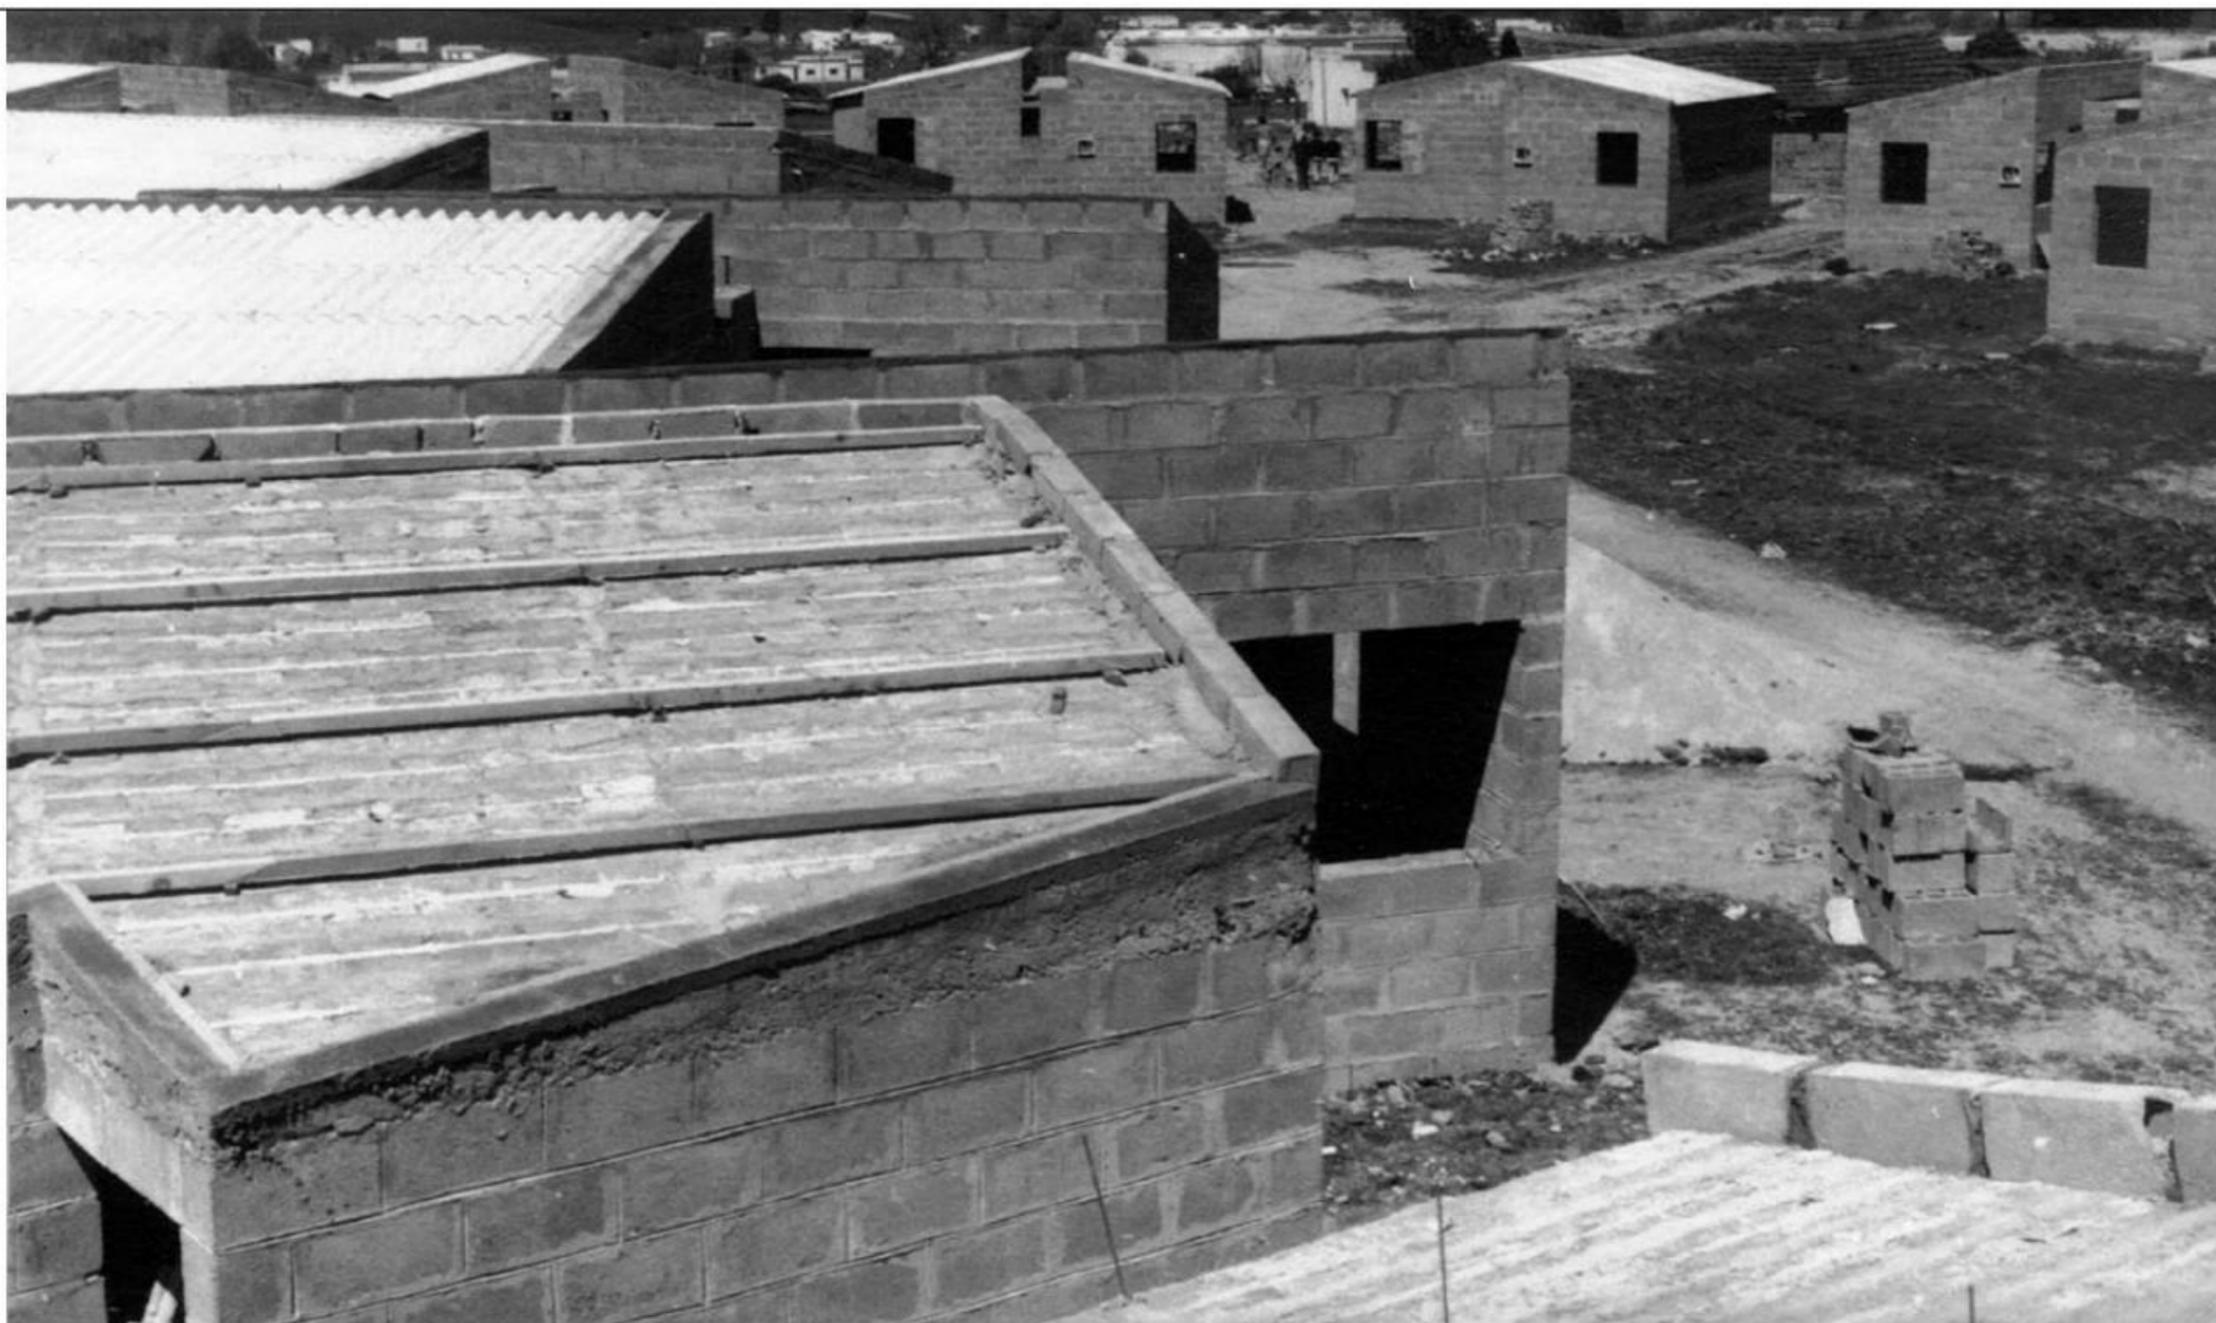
La obra en construcción. Fotografía: Archivo CCU.
